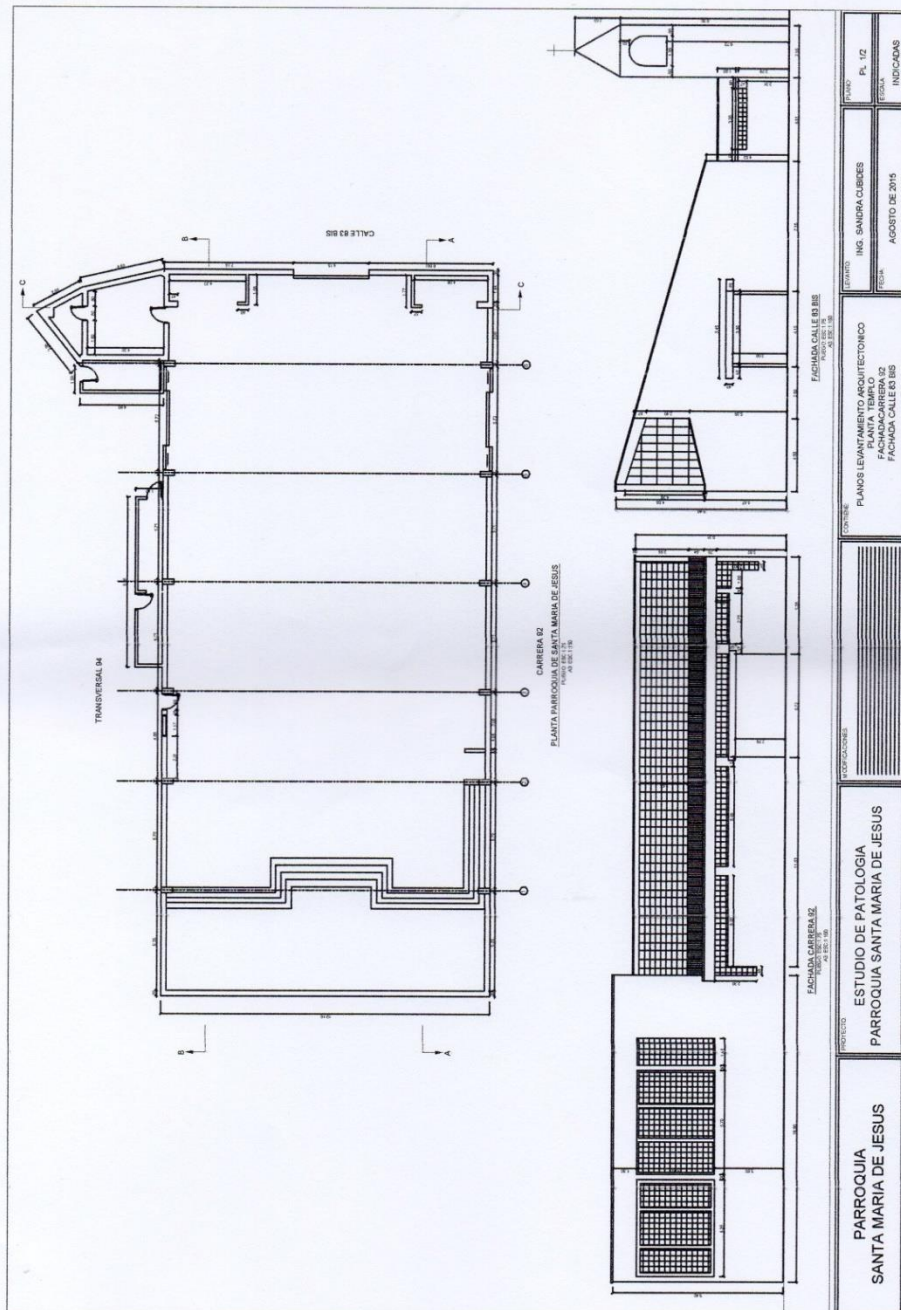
Plano de Levantamiento Arquitectónico (Planta y fachadas)
